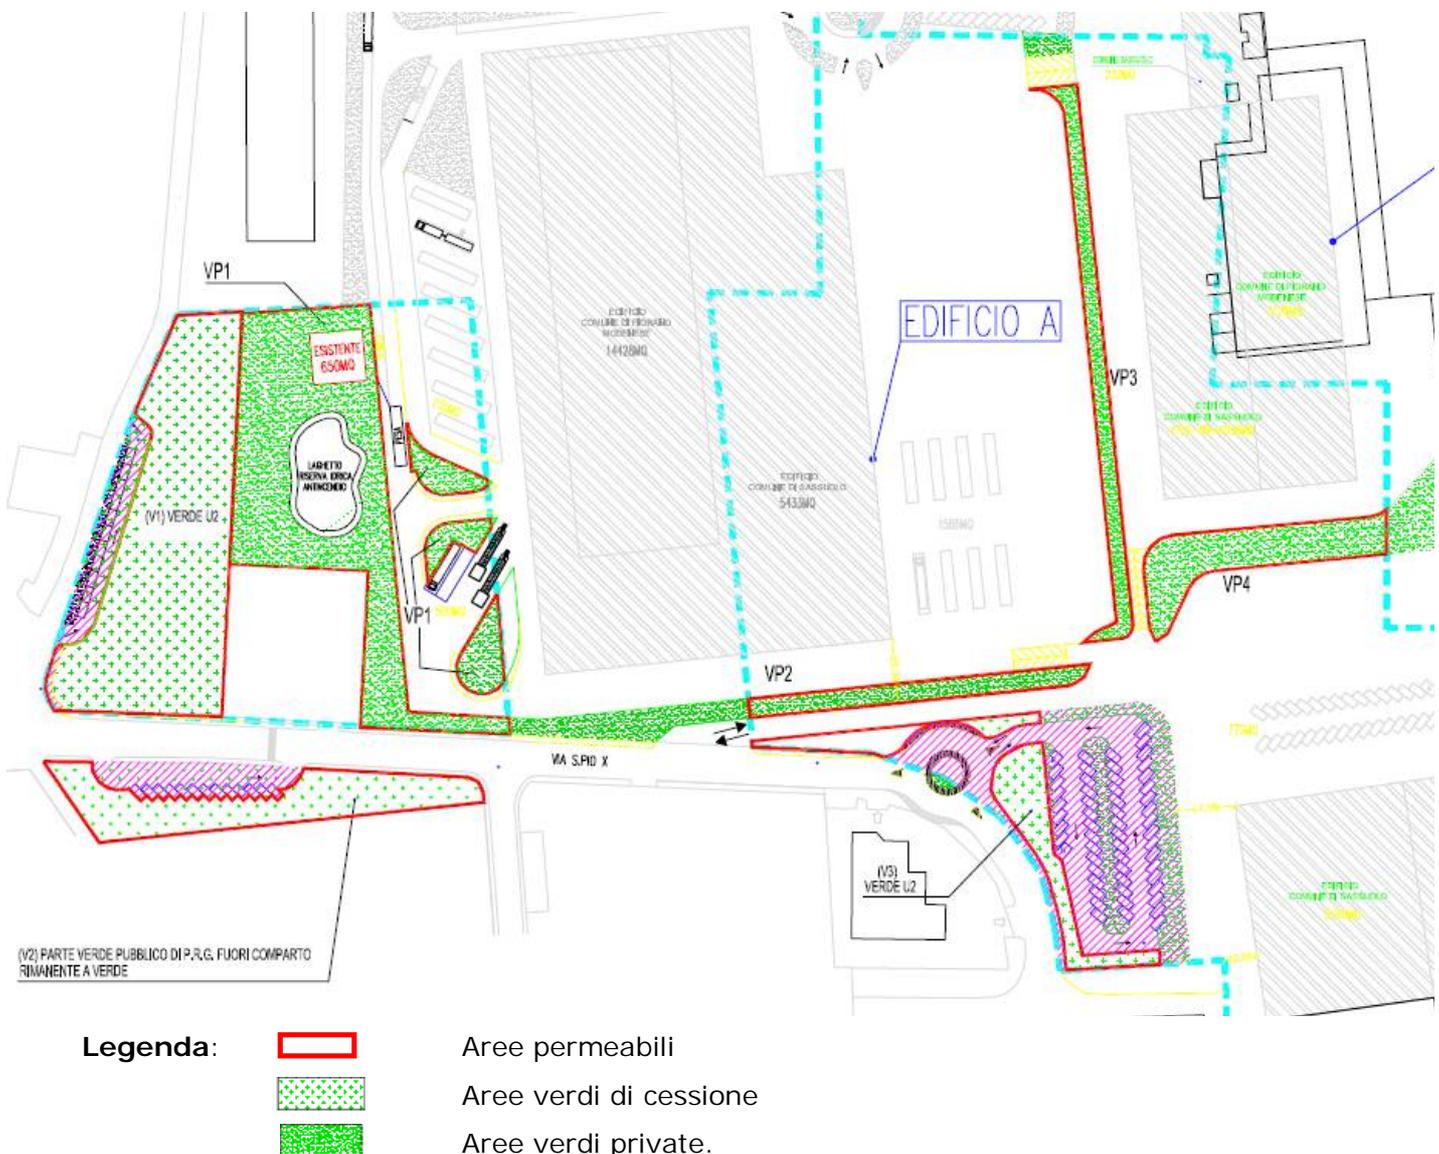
Estratto della Planimetria stato legittimo del comparto di Piano (TAV. 01). Identificazione aree permeabili (Fonte: Elaborazione Terra srl)
